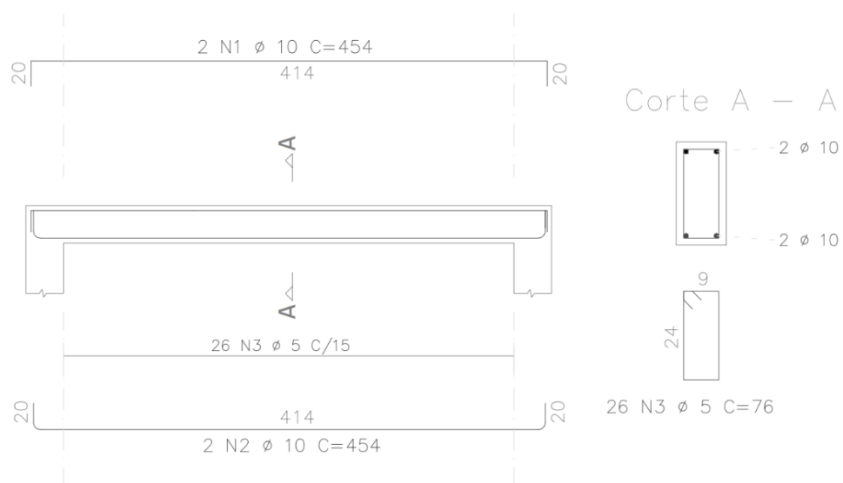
Detalhamento de todas as vigas e vigas baldrames de 4,2 m.
